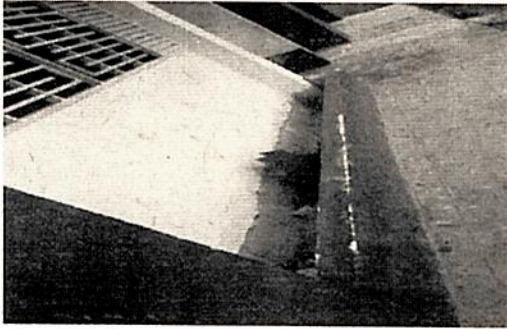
de ancho tallante, pozo séptico en concreto sin funcionamiento de la sede SEDE ESC: RUR MIX URADA
